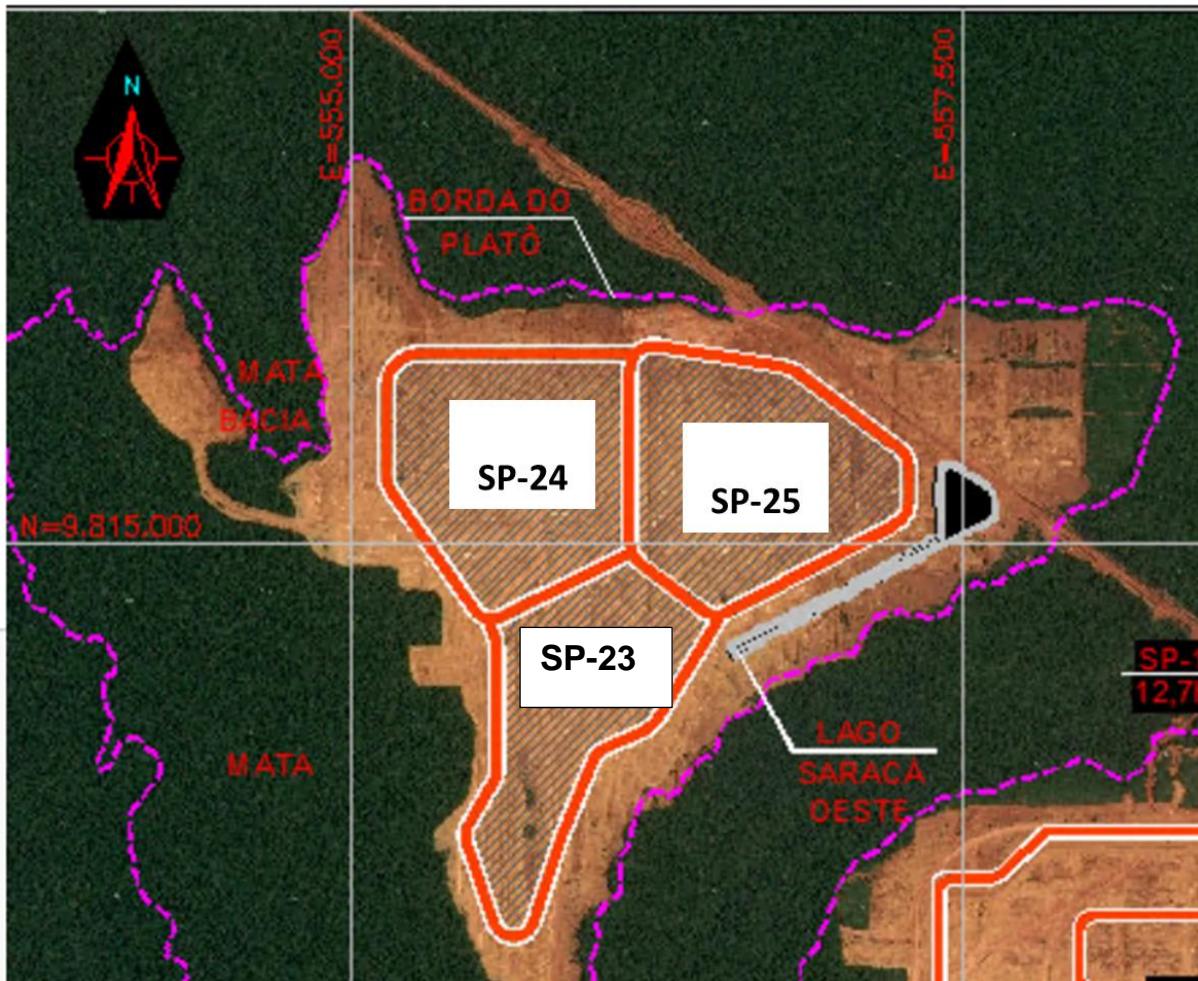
Layout dos tanques projetados para ser utilizado no PNM.
